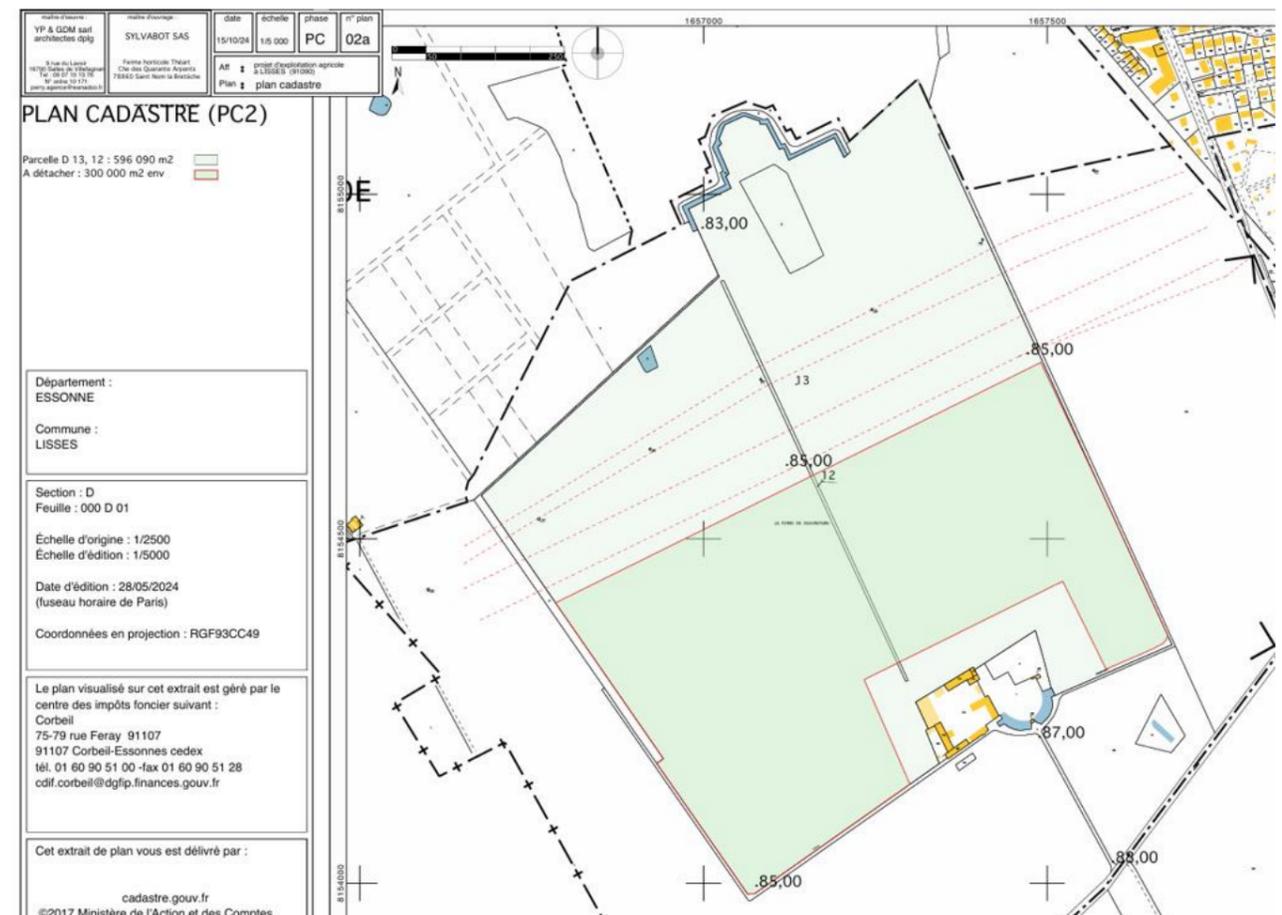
Extrait du plan cadastral au sein de l'AEI (source : Néofarm)
